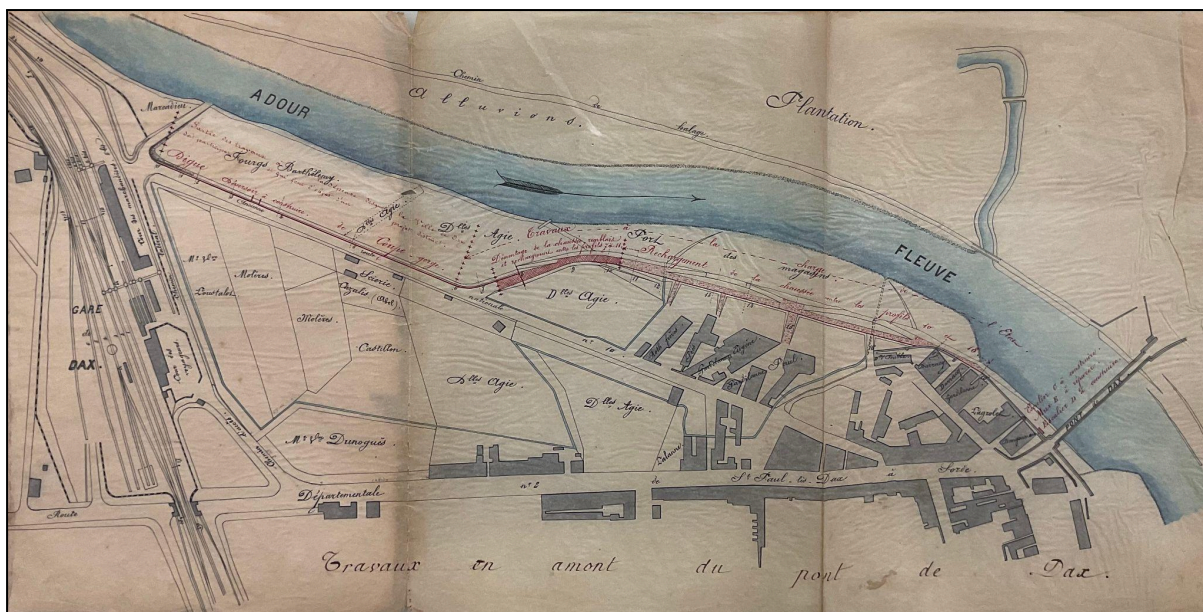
Plan des lieux des travaux de parachèvement des ouvrages de défense du quartier des Magasins contre les inondations, 1883 (Source : AD 40, 3 S 141).
